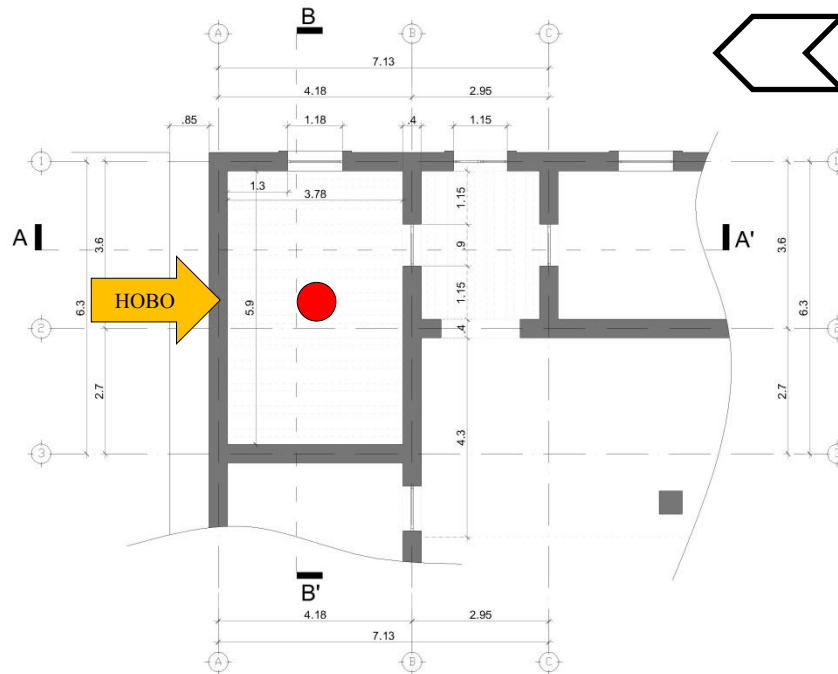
Planta arquitectónica de la vivienda vernácula con ubicación espacial del Hobo.
